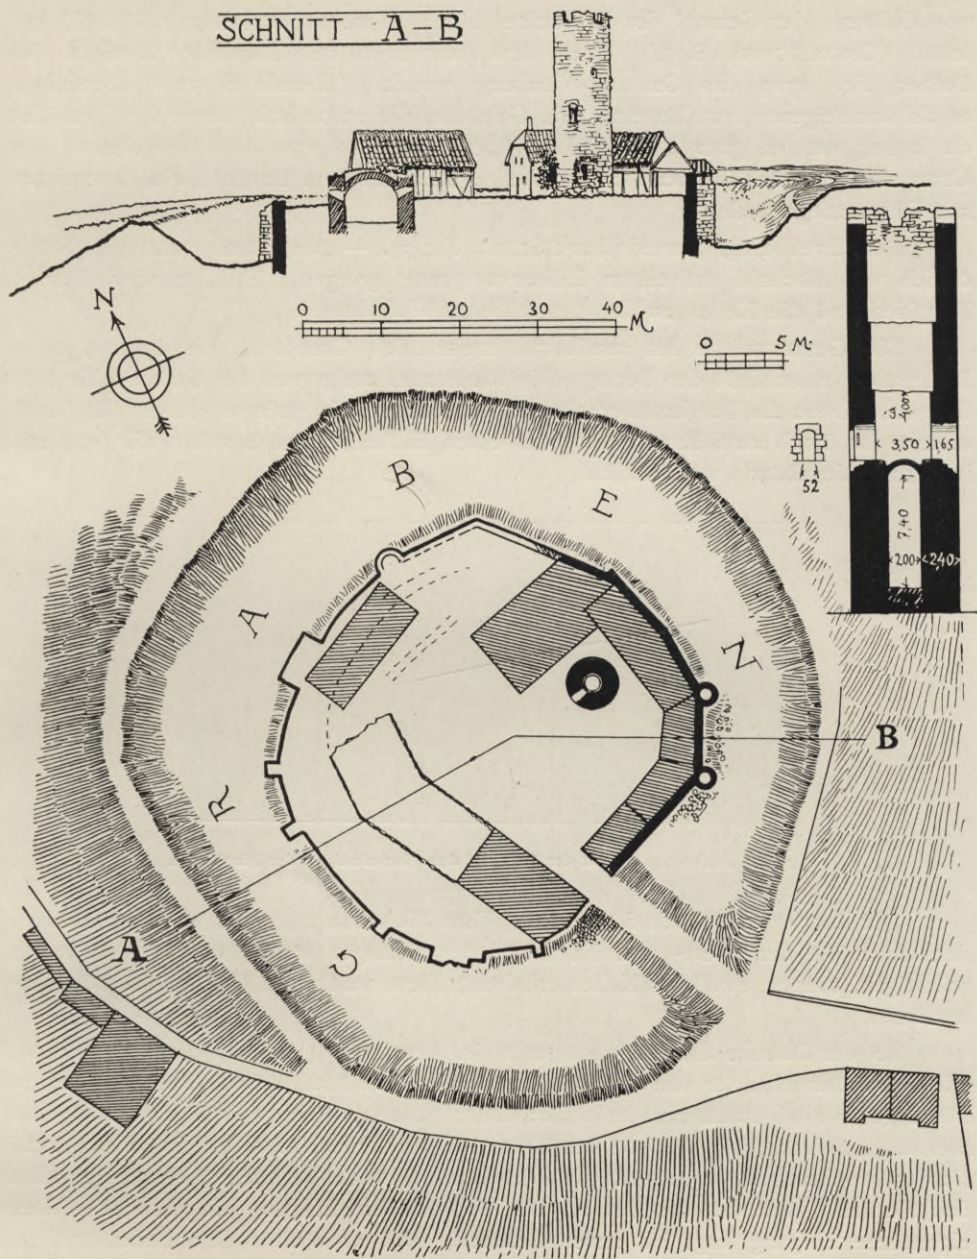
Büchold. Grundriß und Schnitt der Burgruine.
